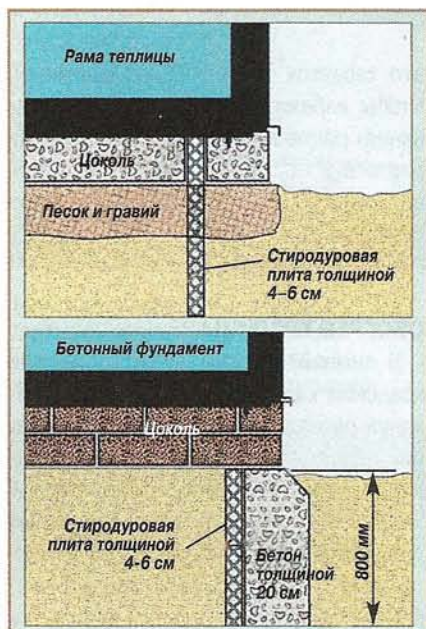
Фундамент под теплицу. Сборный комплект теплицы поставляется вместе с планом фундамента, который можно затребовать заранее.
